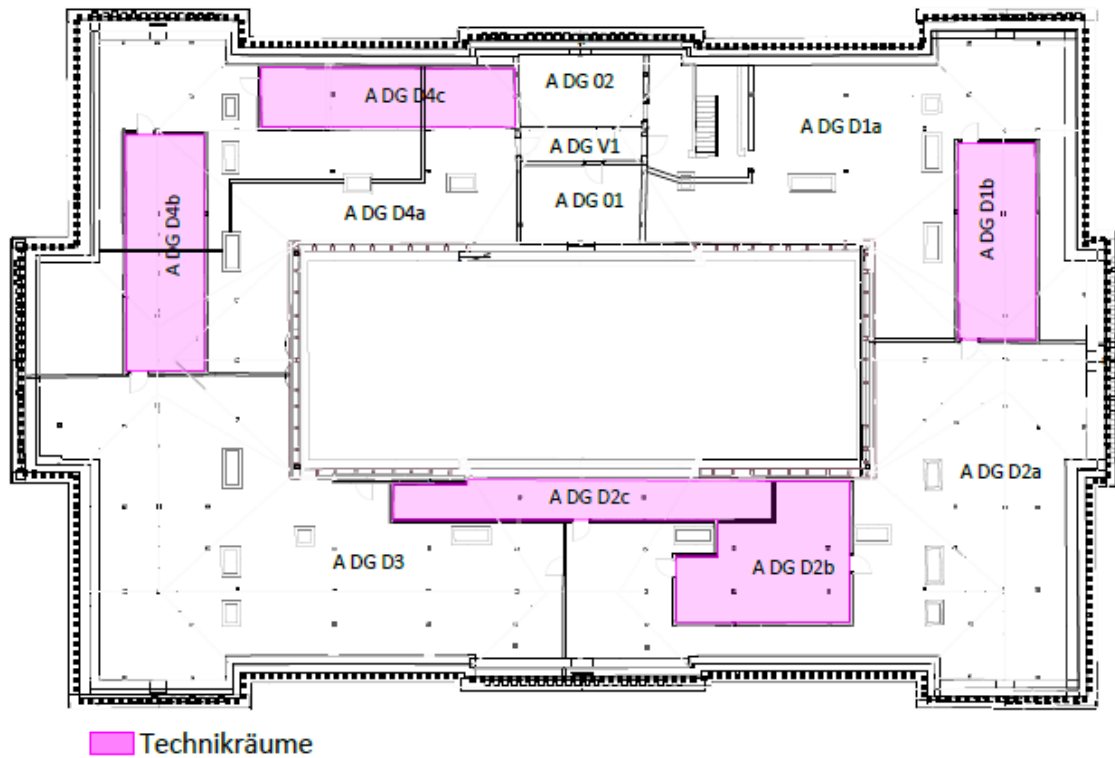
Grundriss 2. Obergeschoß
